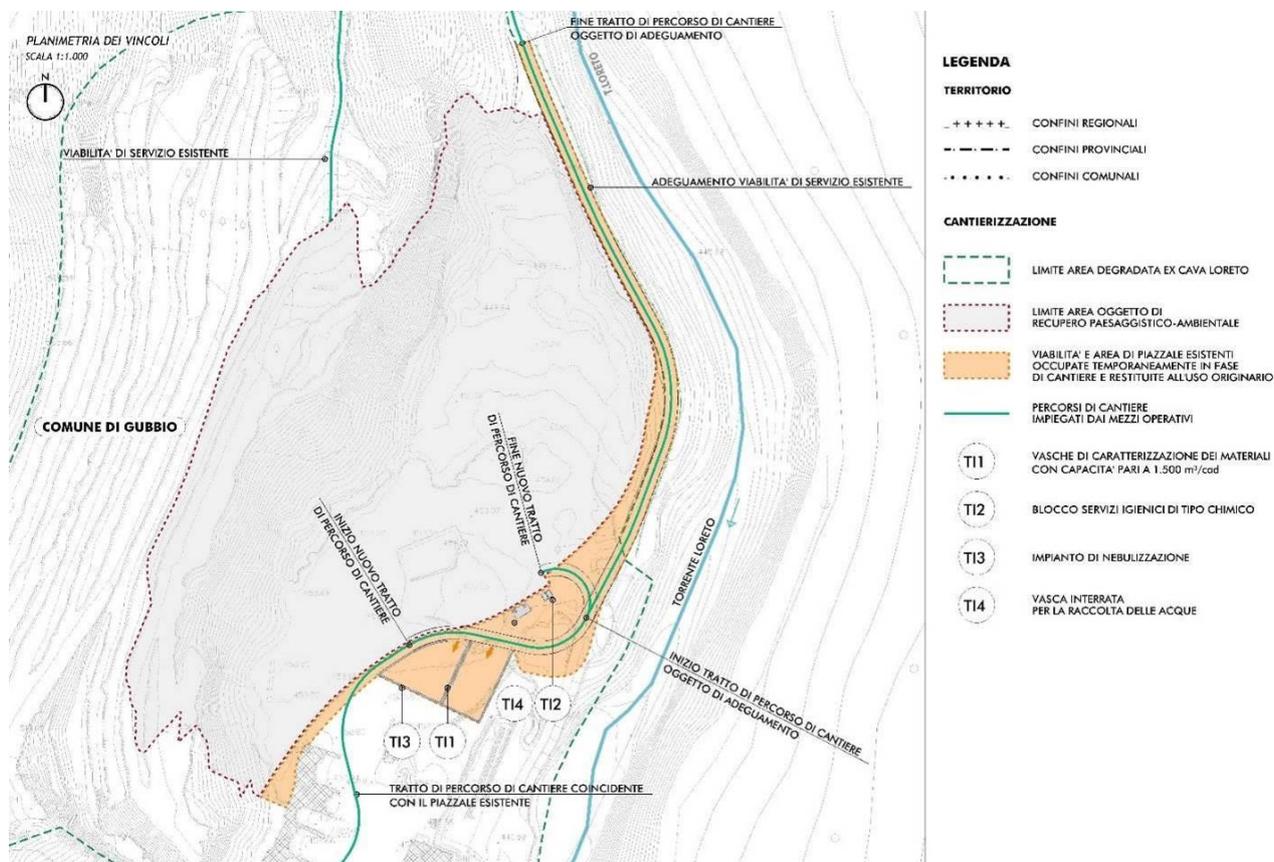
LAY-OUT FUNZIONALE DELL'AREA DI CANTIERE "E"
